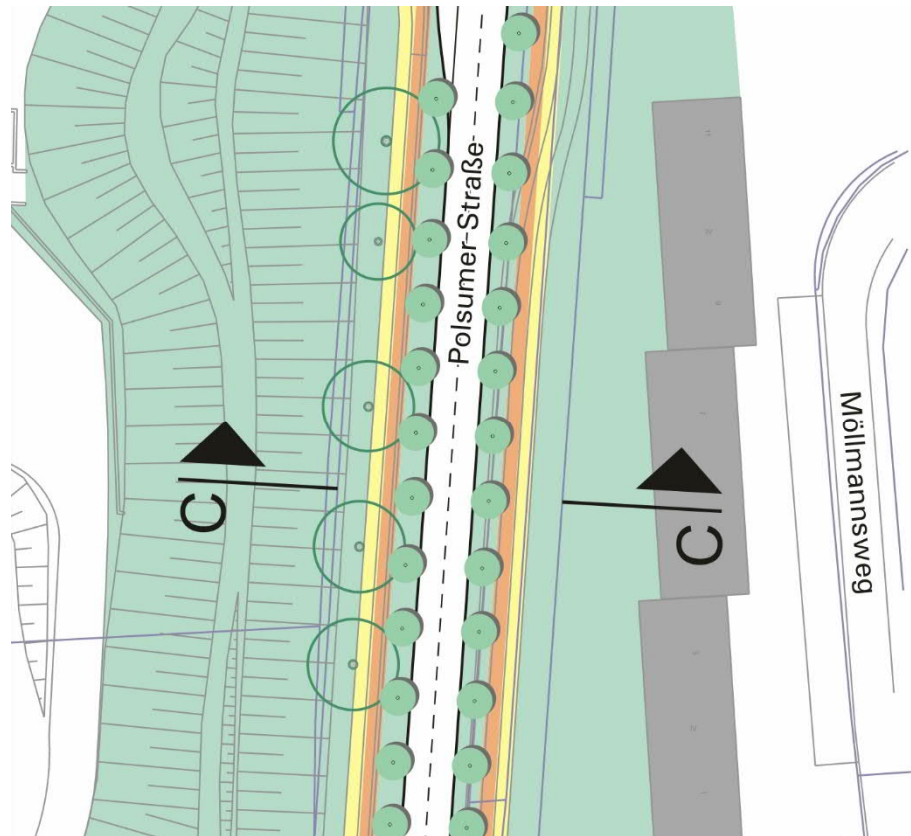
Lageplanausschnitt Außerorts – Variante 2 zweistreifiger Fahr-
